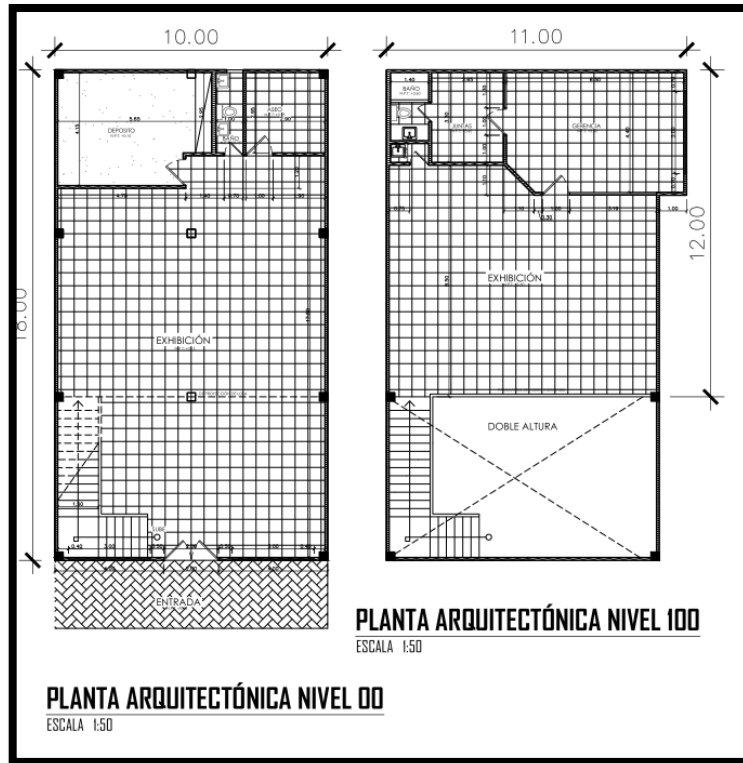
Planta arquitectónica nivel 00 y nivel 100 (local comercial de dos plantas)
